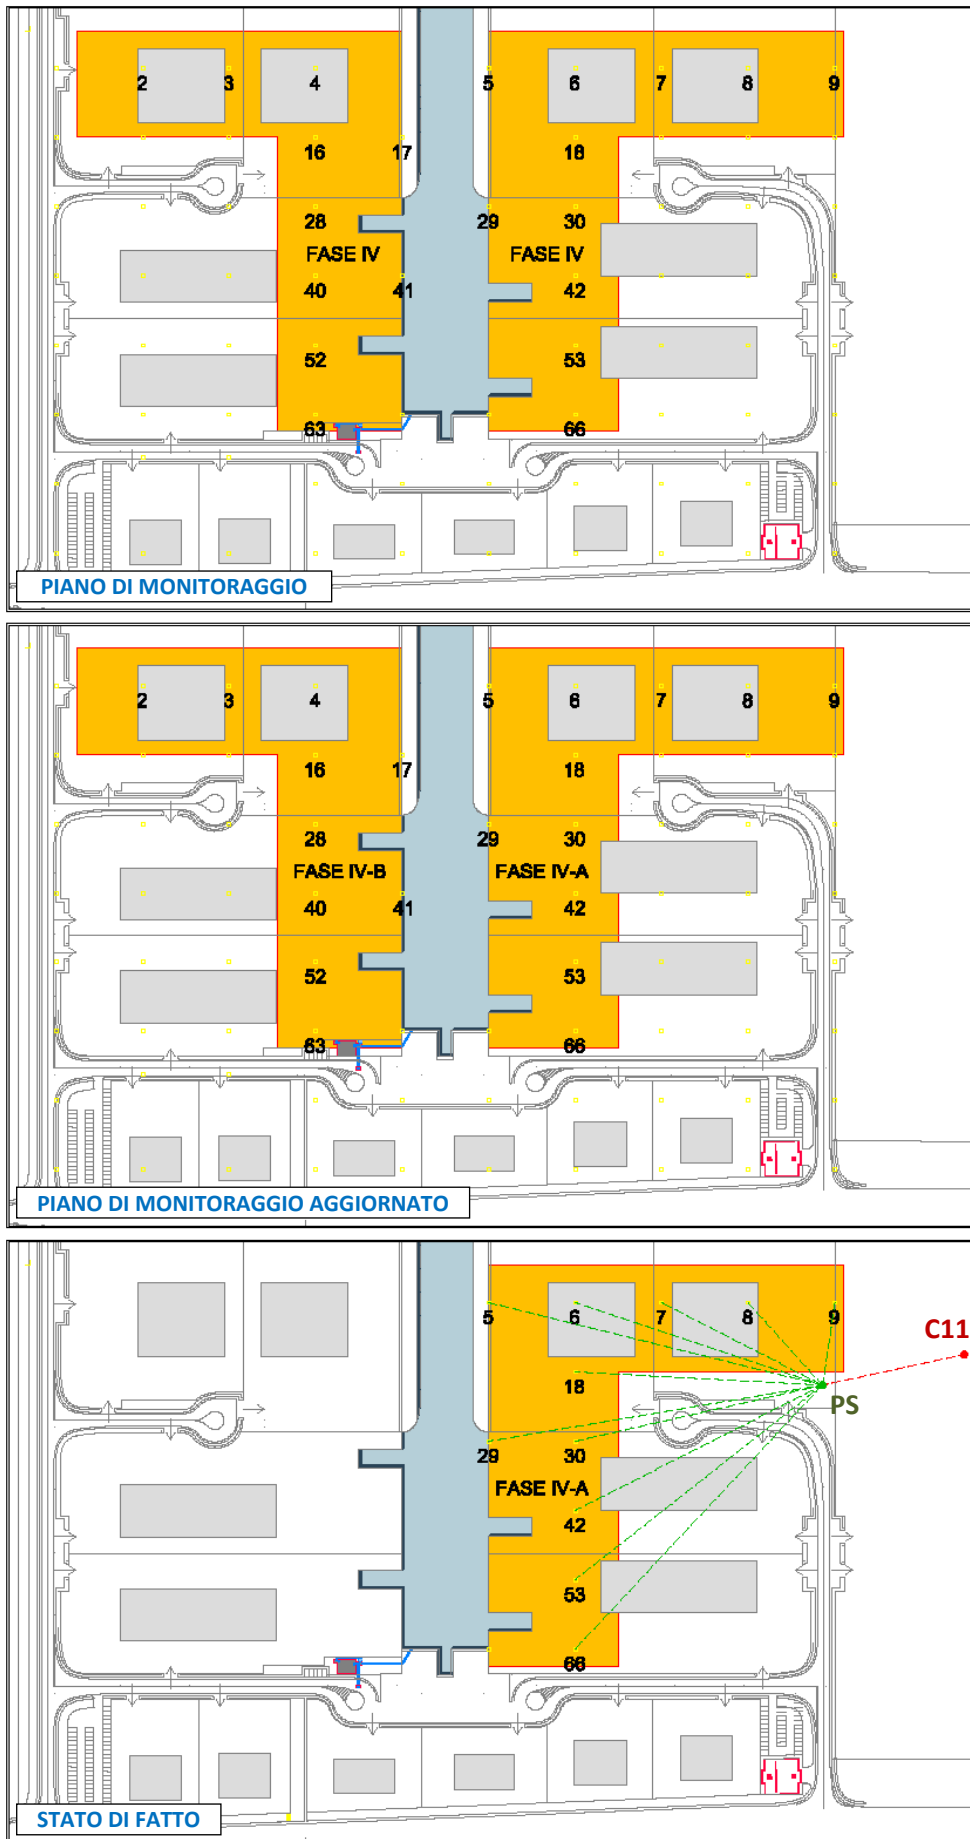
Planimetria delle stazioni di monitoraggio di IV FASE.
